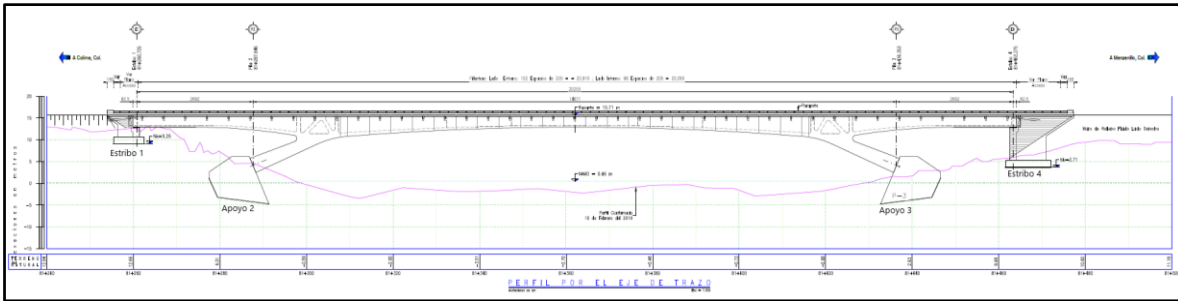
Perfil del Nuevo Puente Tepalcates II, tipo pórtico.
